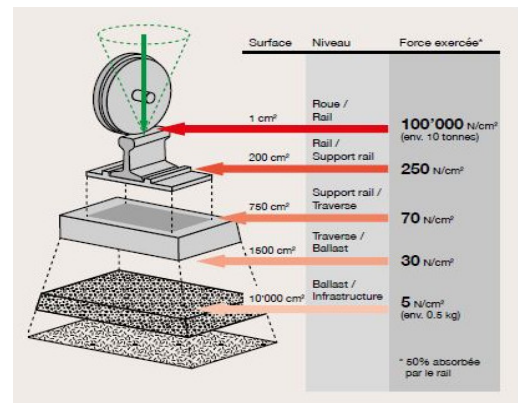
Structure d'une Voie ferrée ; Source : Mieux comprendre la voie ferrée.pdf
